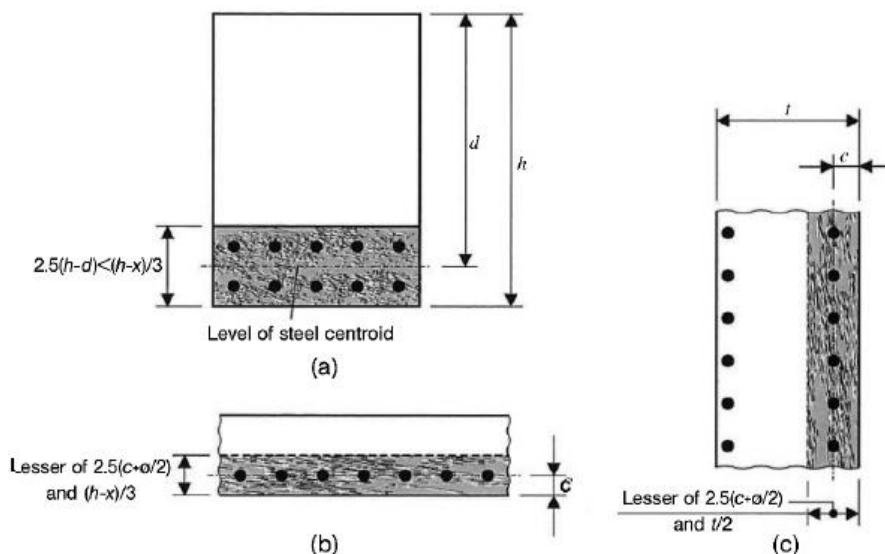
Método para a determinação da área efetiva de betão: a) vigas; b) lajes; c) elementos em tração (CEB-FIB 2010)
